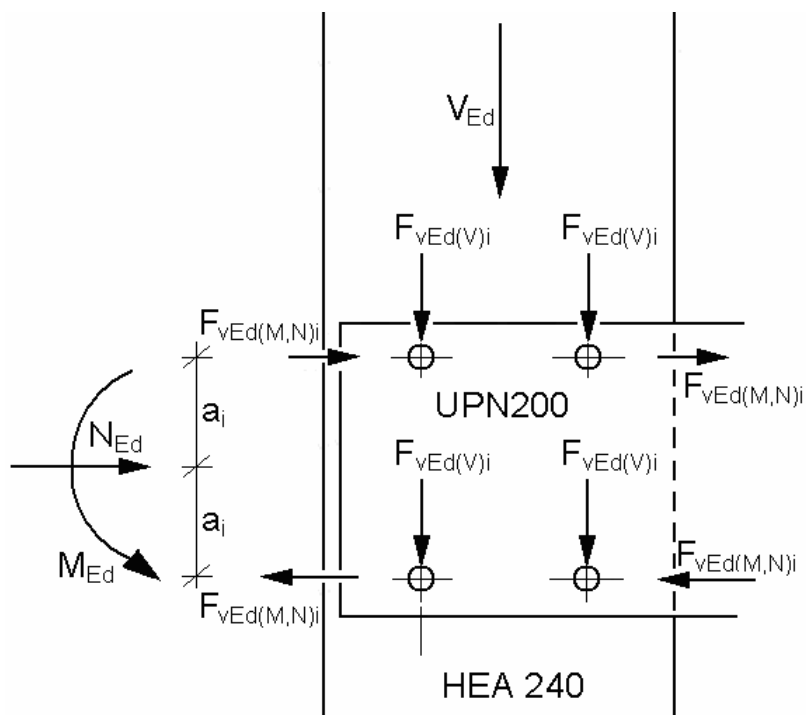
PIASTRE – DEFINIZIONI DELLE GRANDEZZE GEOMETRICHE
